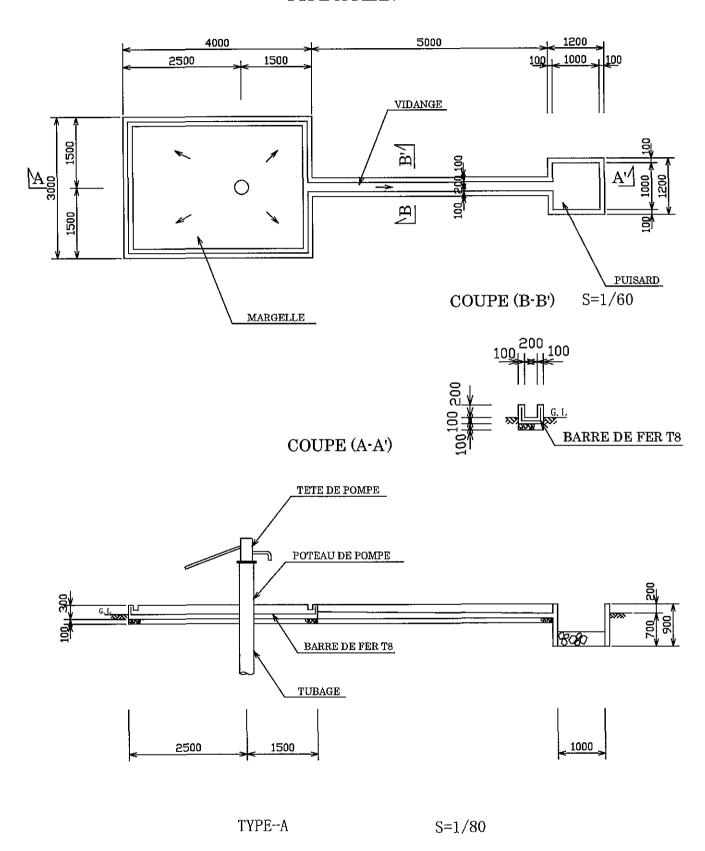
Structure standard des installations secondaires des forages (pompes manuelles)
